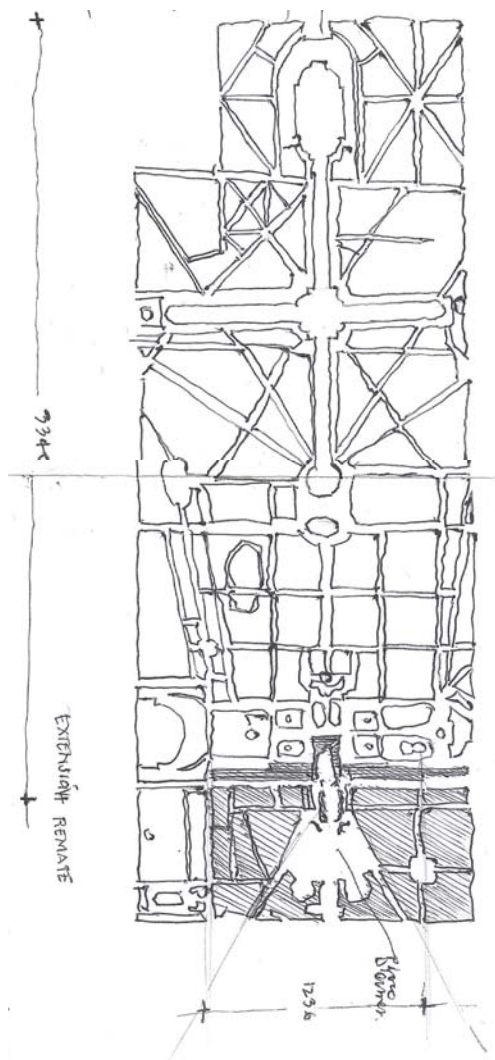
Palacio de Versalles. Esquema de la planta general. Elaboración propia.
